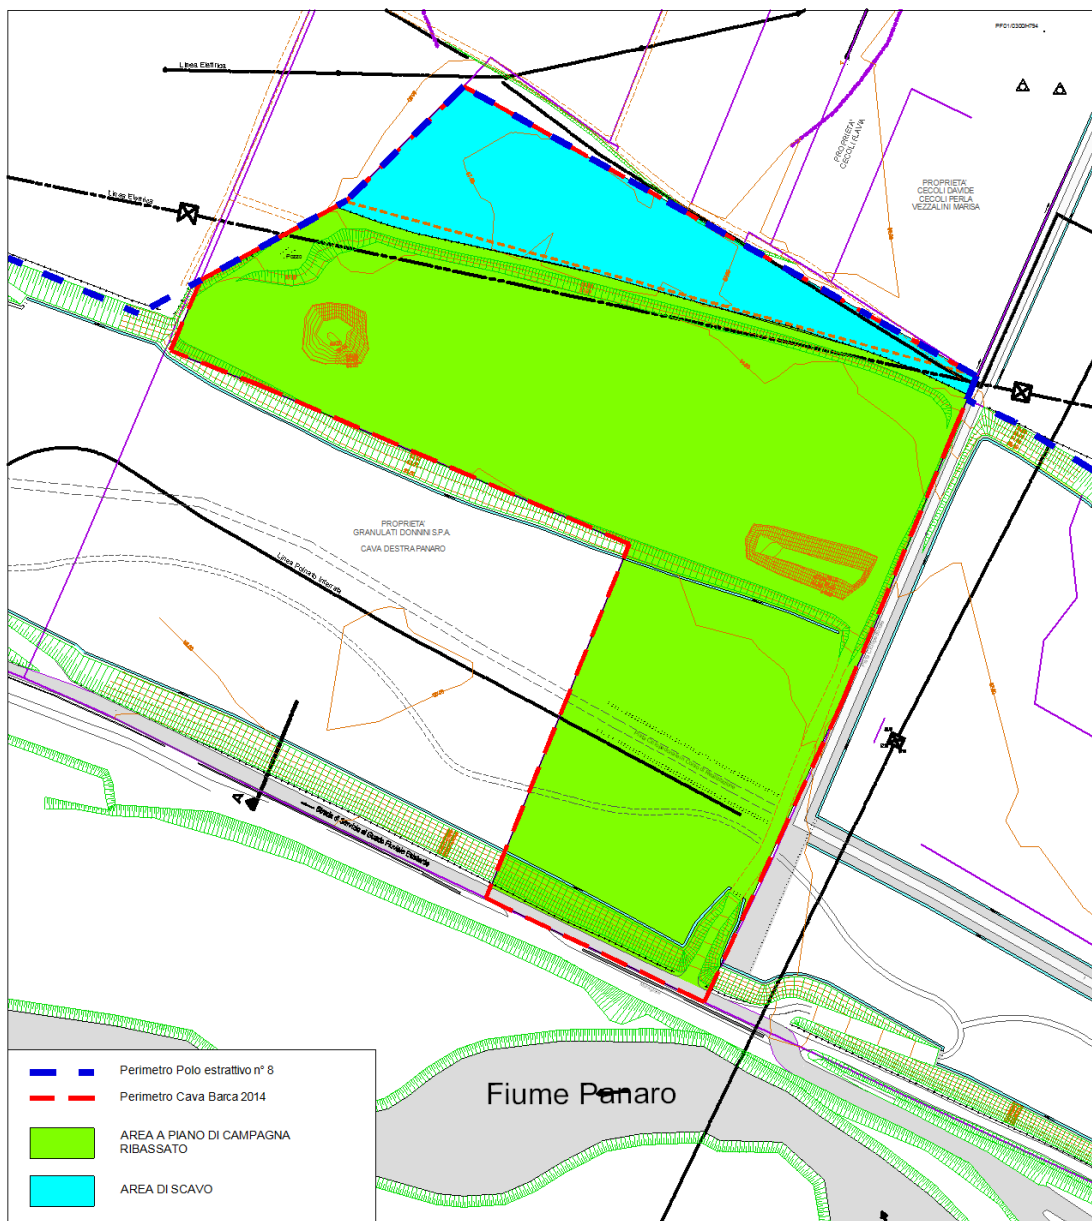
Planimetria dello stato di fatto (scala 1:3.000)
